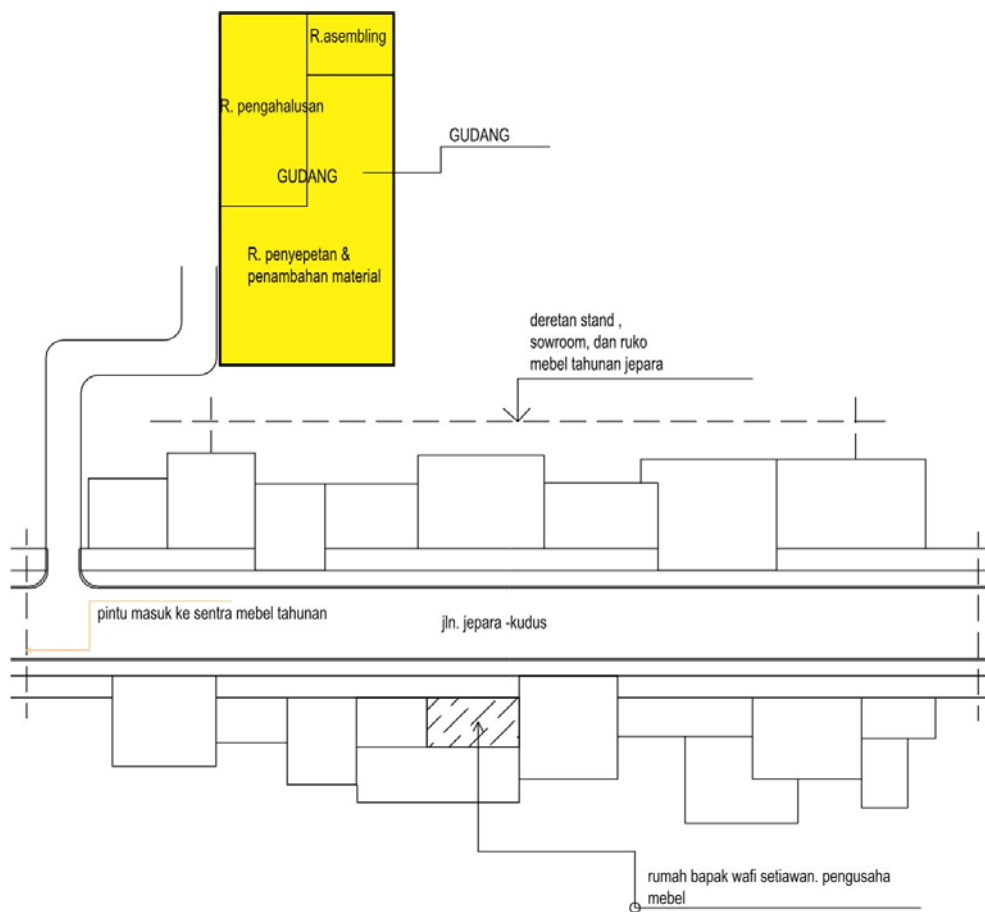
denah stand penjualan mebel bapak wafi setiawan di tahunan jepara. Foto dok.pribadi
